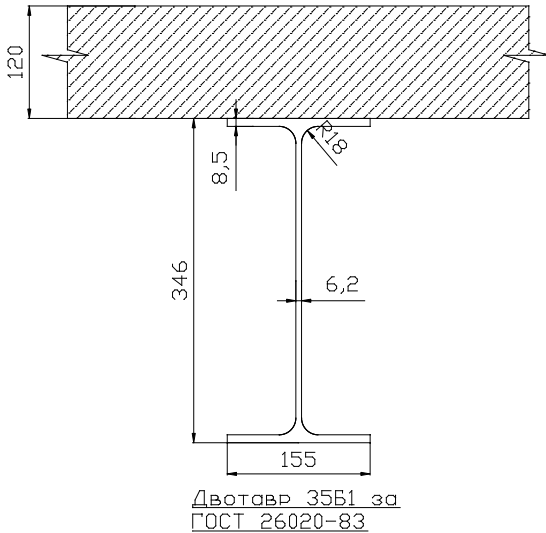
Схема конструкції, що складається зі сталеві балки, на яку опирається бетонна плита перекриття
